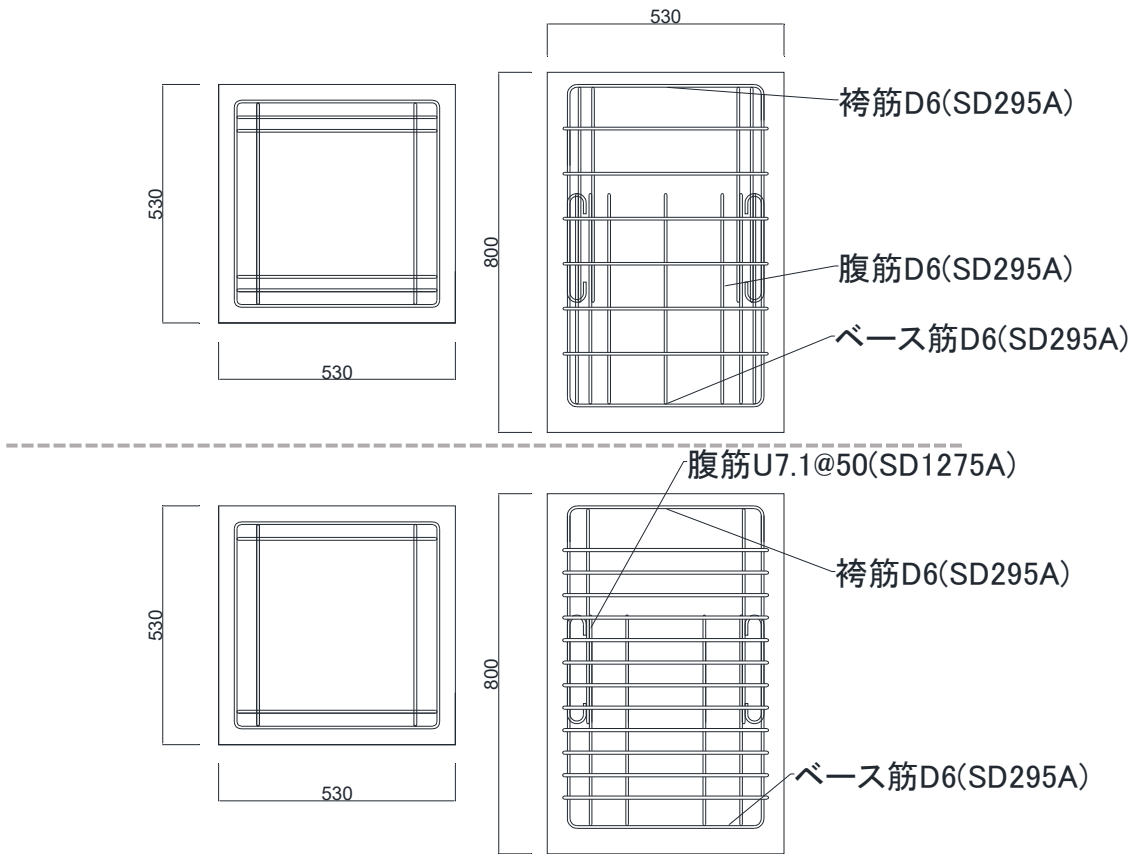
パイルキャップ断面図 (上 : E-1 下 : E-2)
